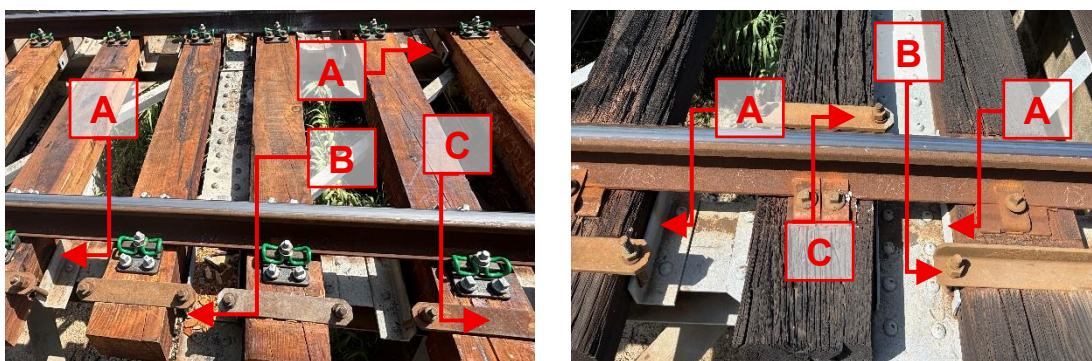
Ponte da Várzea, Fixação das Travessas à estrutura
